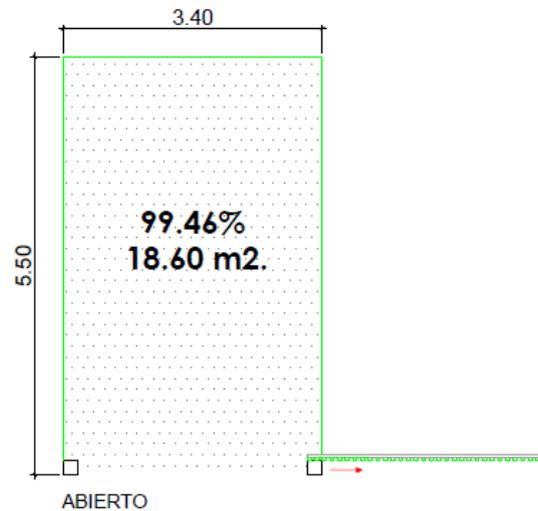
Vista en planta de la superficie del garaje con puerta abierta.
